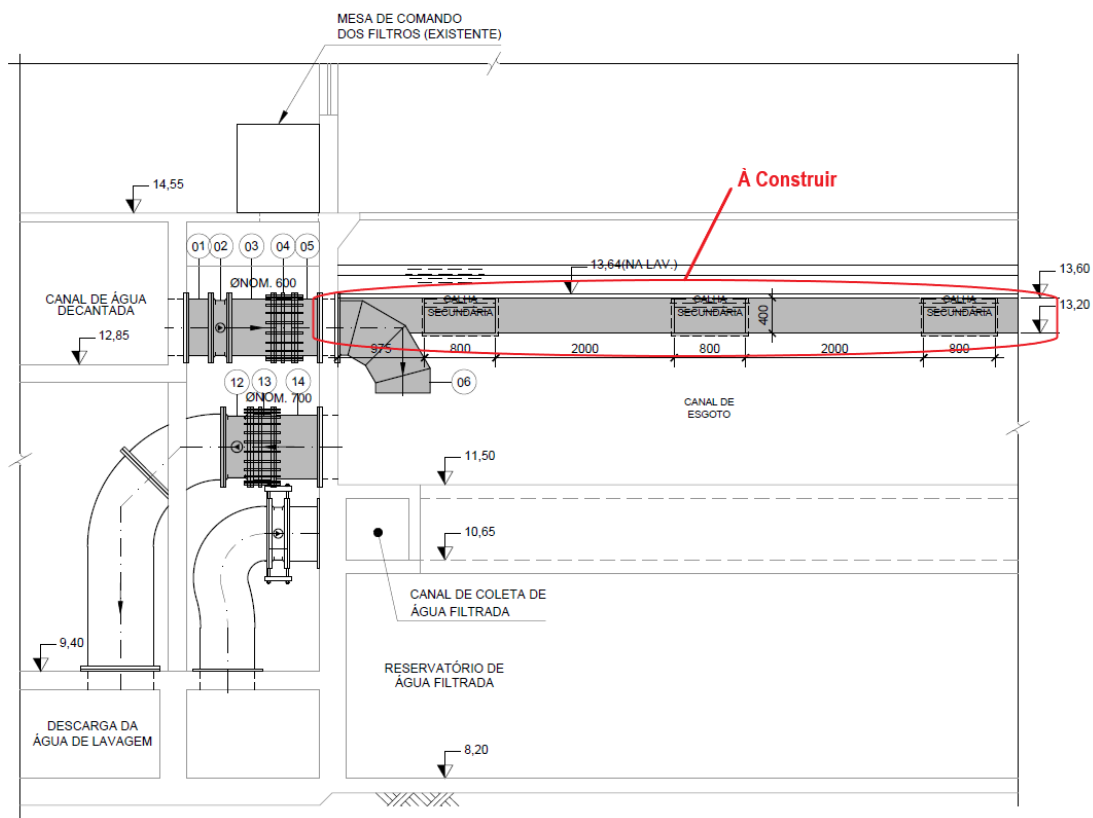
Corte longitudinal do filtro com a indicação da complementação em concreto armado da parede da calha de lavagem.
